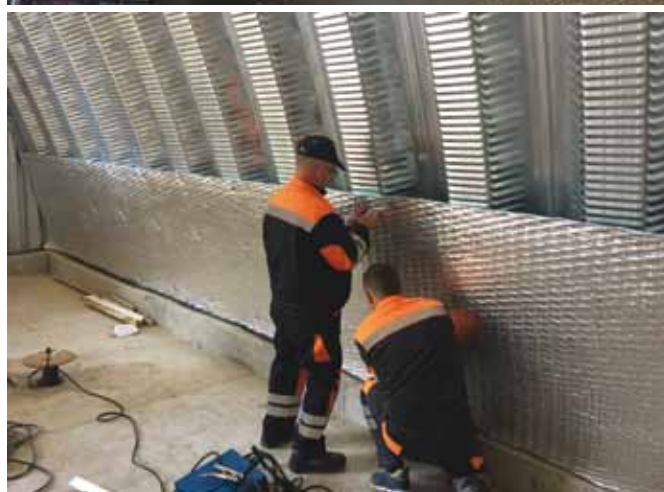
Монтаж отражательной теплоизоляции ПЕНОФОЛ® тип В толщиной 30 мм к внутренней поверхности бескаркасного ангара
